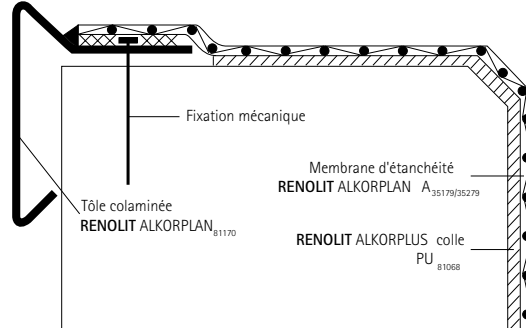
Collage en plein de la membrane RENOLIT ALKORPLAN A
